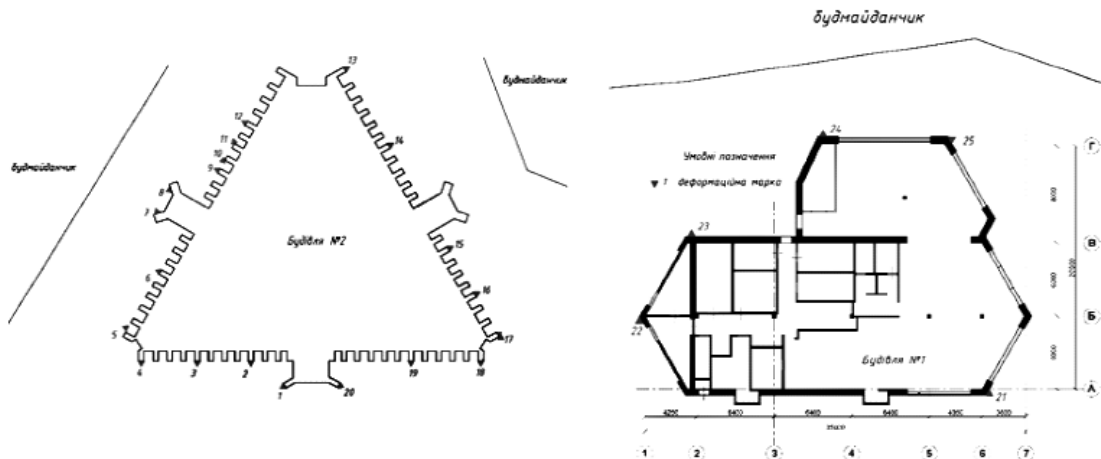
Схеми розташування деформацій на будівлях прилеглої існуючої забудови
